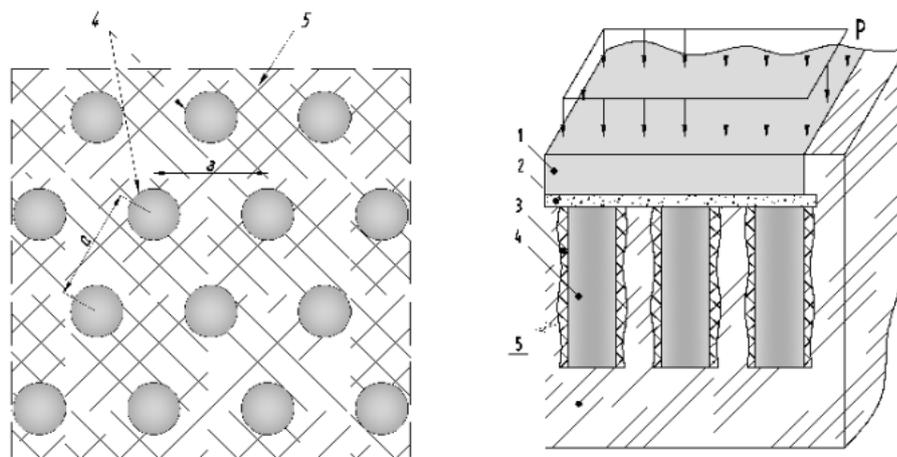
Схема та фрагмент поперечного перерізу структурного геомасиву: 1 – плита; 2 – розподільна щебенева подушка; 3 – зона ущільнення ґрунту; 4 – армуючий (ґрунтоцементний) елемент; 5 – природний ґрунт; а – крок ґрунтоцементних елементів; Р – зовнішнє навантаження на фундамент.
